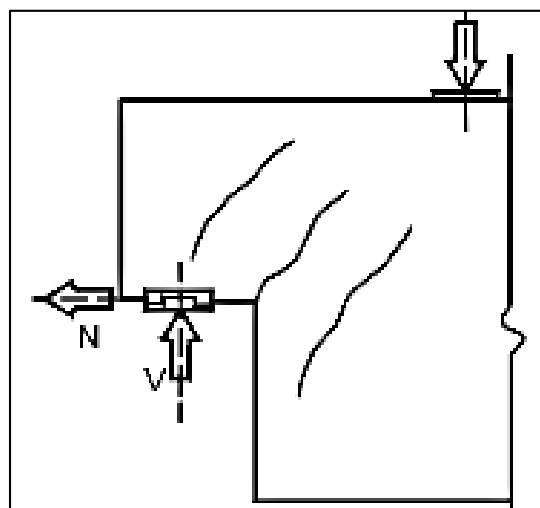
Patrón de fisuración típico en el extremo entallado de una viga bajo cargas de servicio
